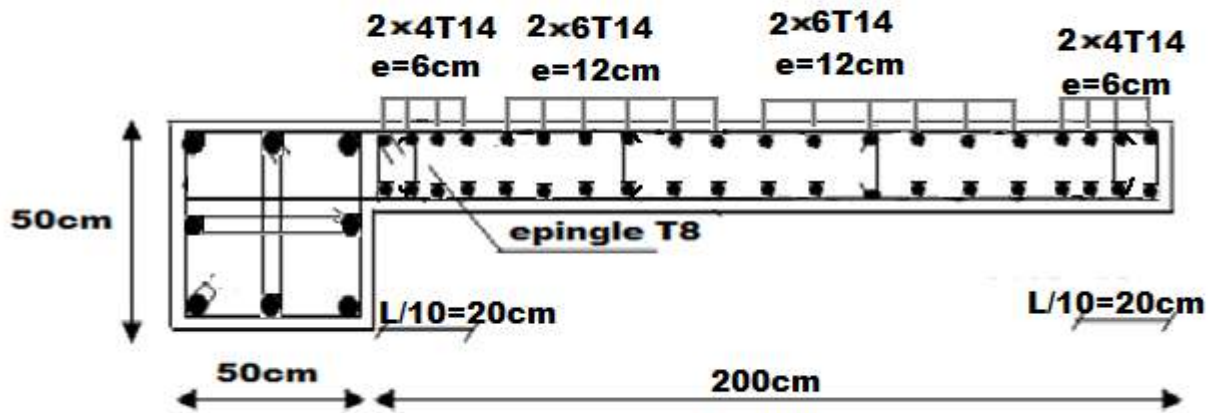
Schéma ferrailage du voile (V3) coupes horizontaux
